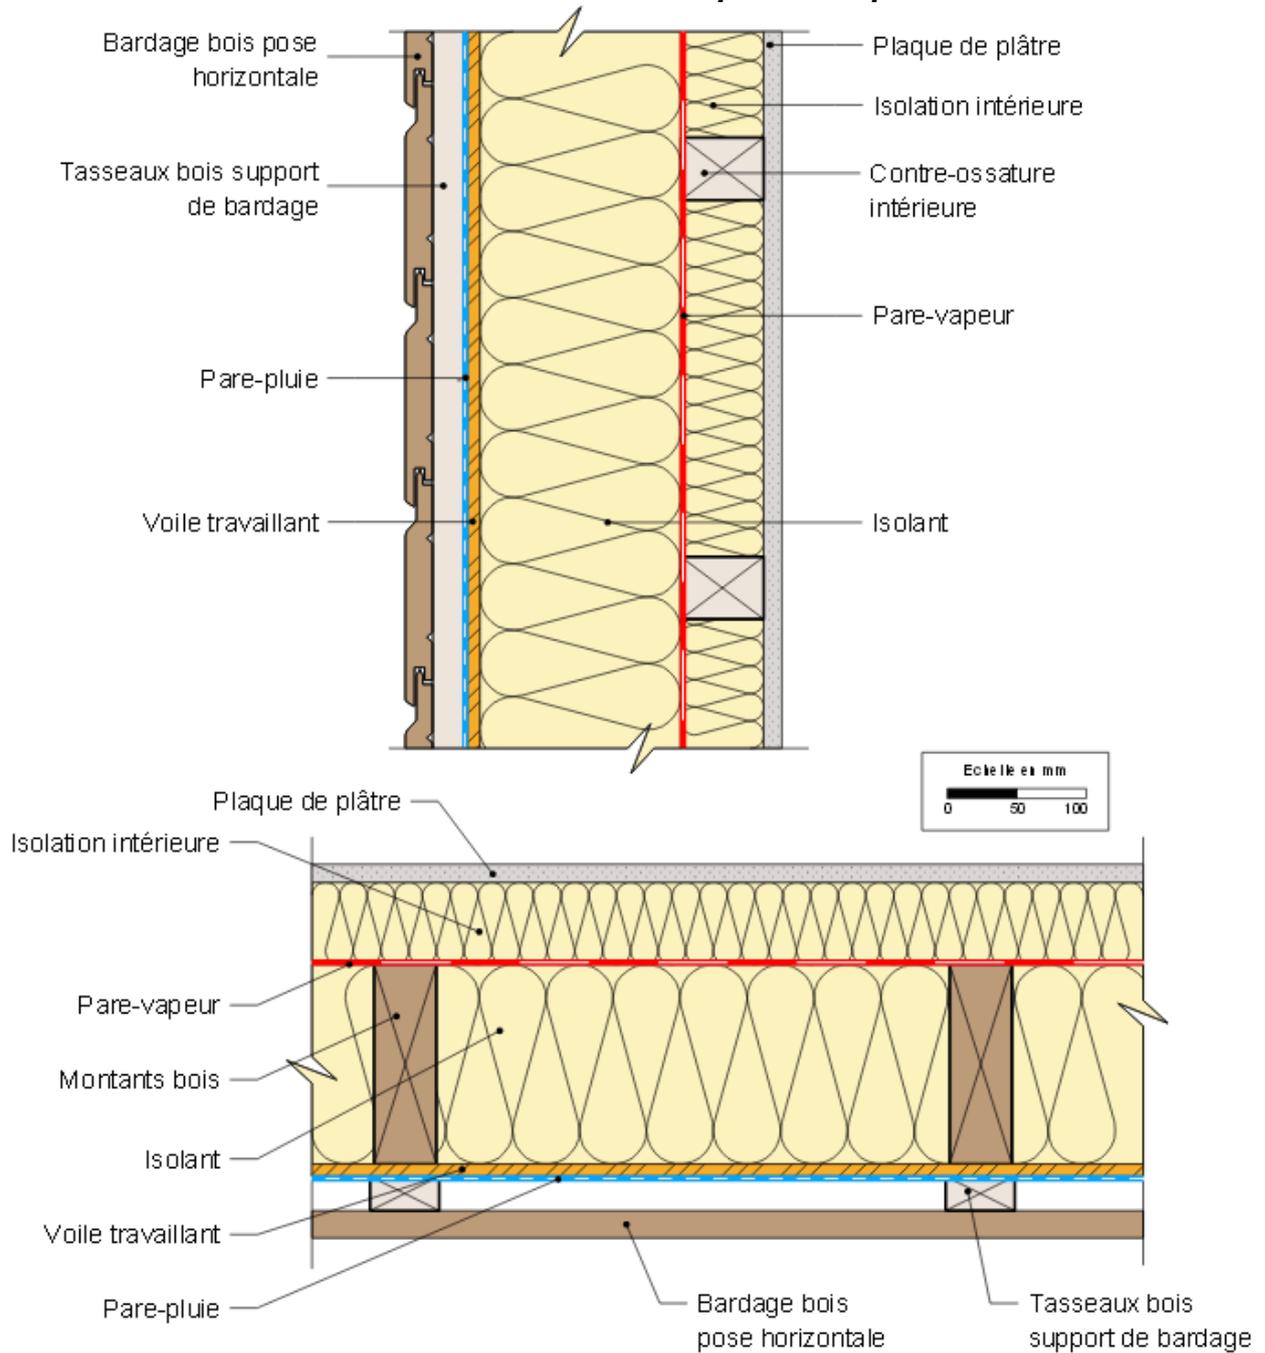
Doublage isolant par l'intérieur (coupe verticale en haut, verticale en bas)
